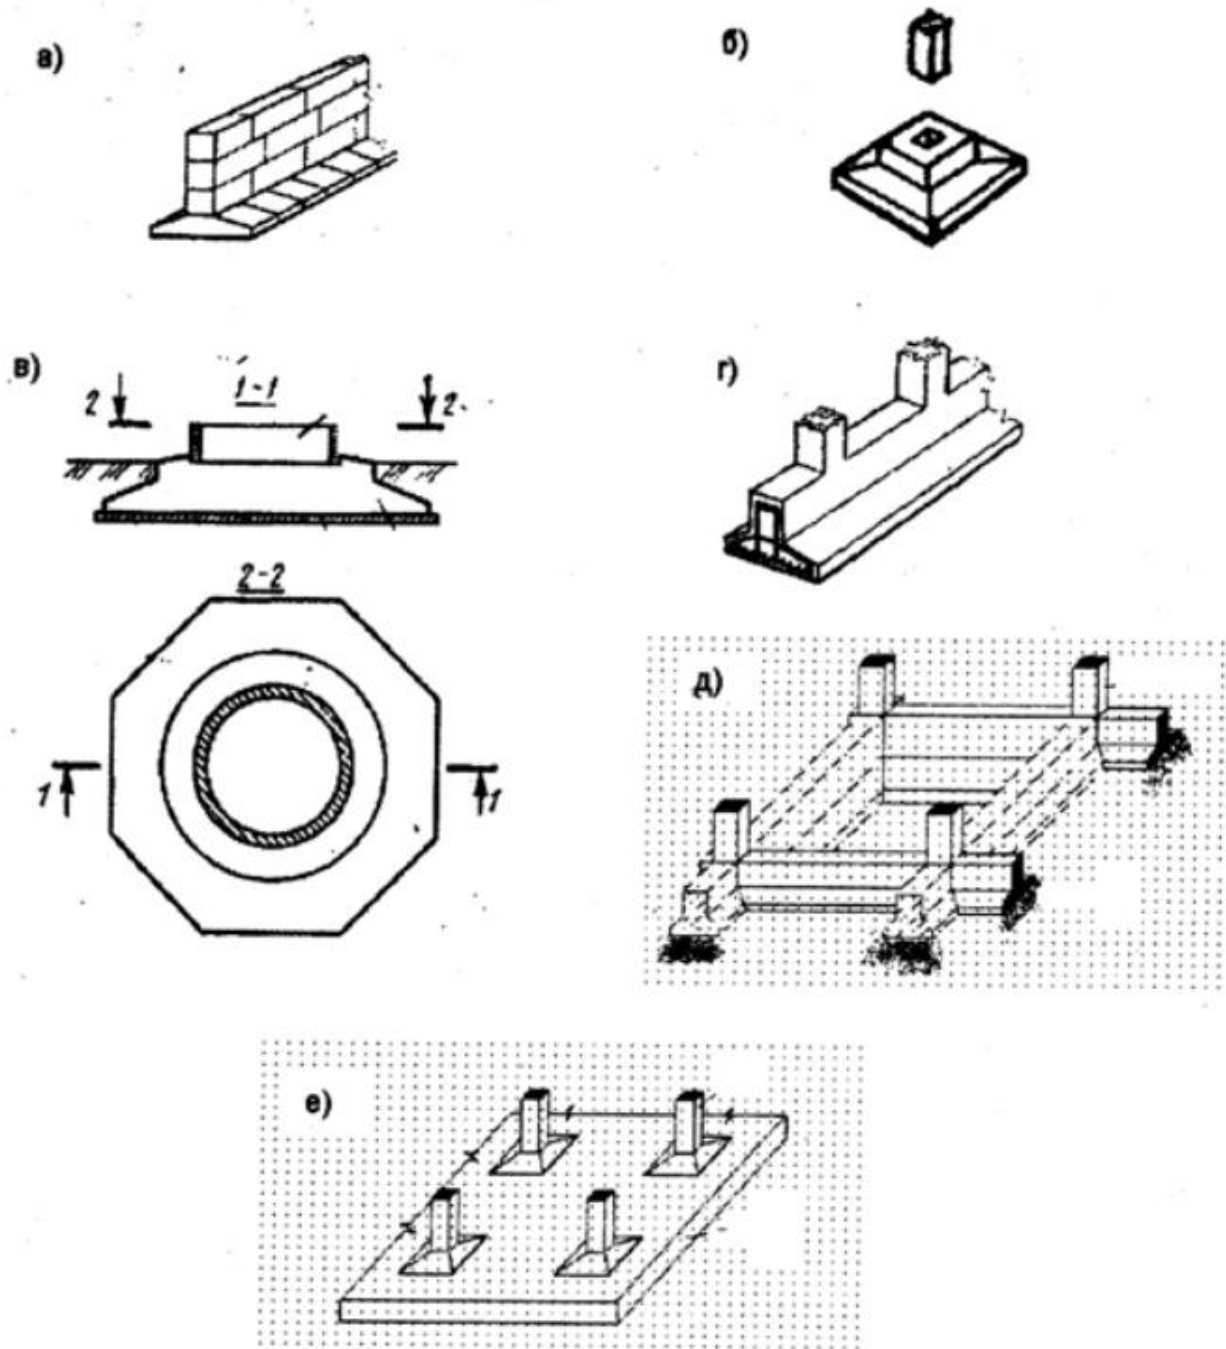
Типи фундаментів: а) збірний стрічковий фундамент під стіну; б) окремий збірний фундамент стаканного типу; в) масивний фундамент; г) монолітний стрічковий фундамент під колони; д) фундамент з перехресних стрічок; е) суцільна плита під колони.
